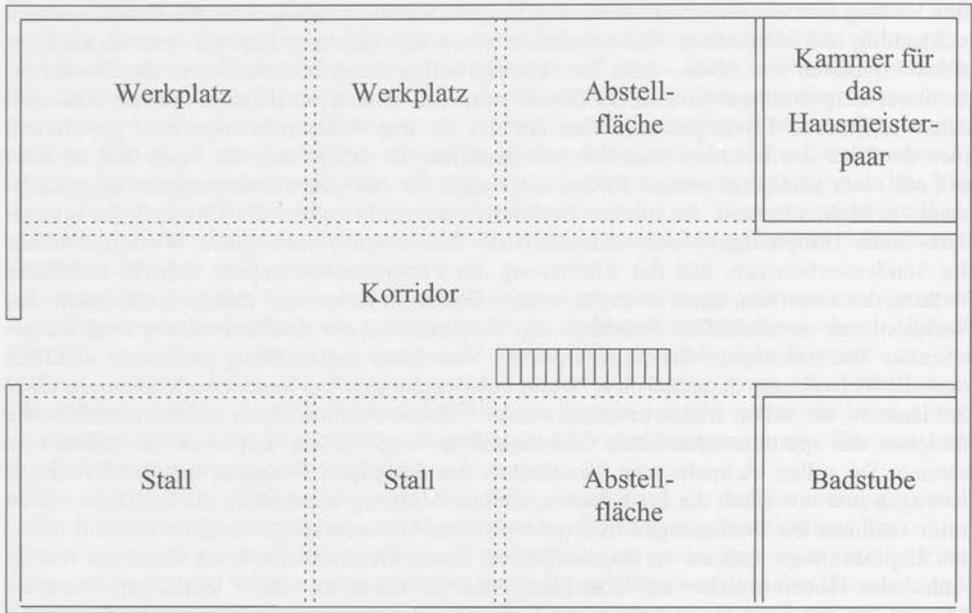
Schematische Darstellung des Grundrisses des Erdgeschosses.
